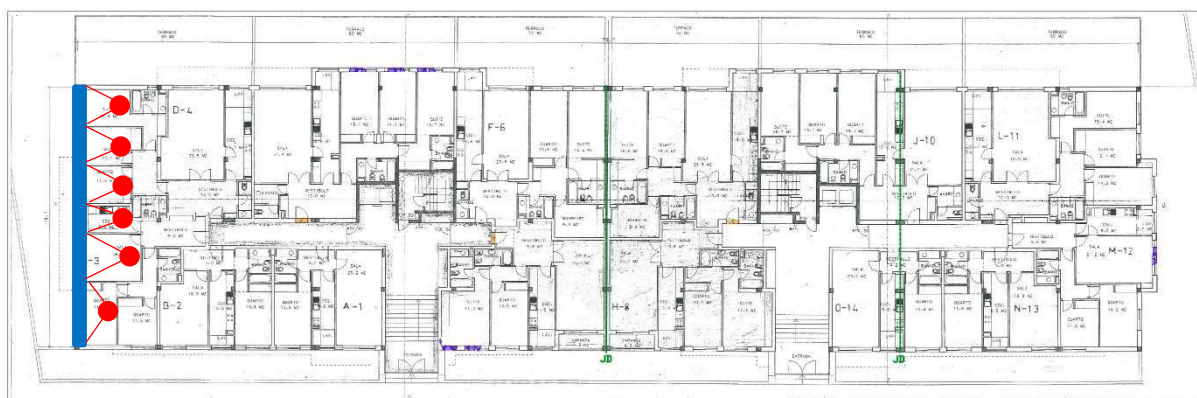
Estudo do posicionamento dos equipamentos sobre as plantas do edifício (elaboração própria)
